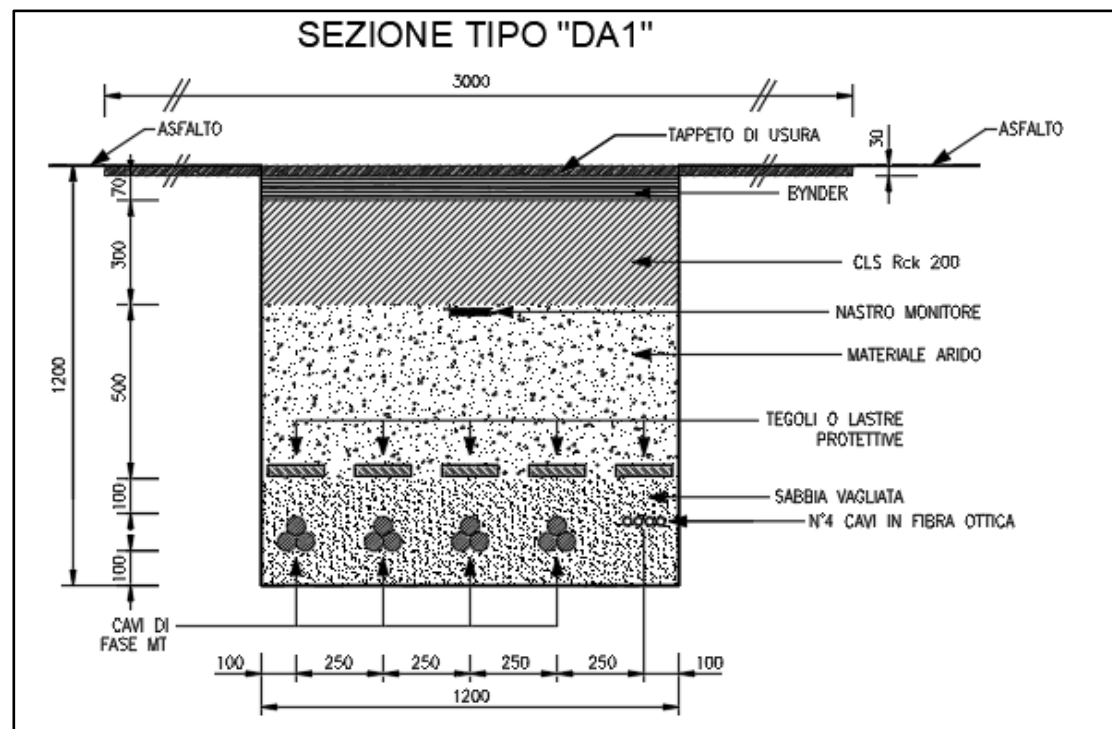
Sezione tipo DA1 estratta dal progetto per posa su strade asfaltate
